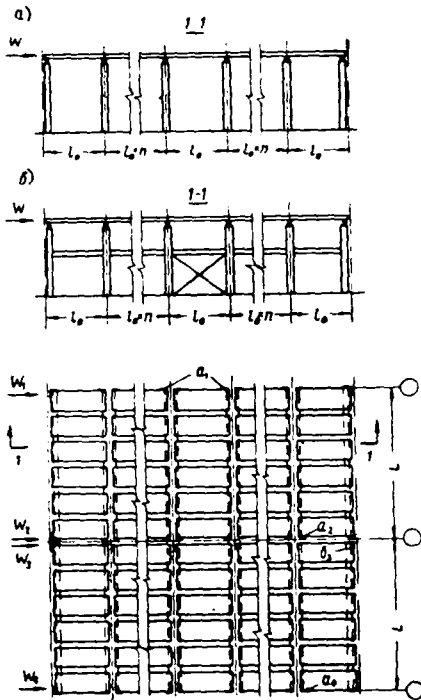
Расчетные схемы (1 и 2) диска покрытия со скатной кровлей
